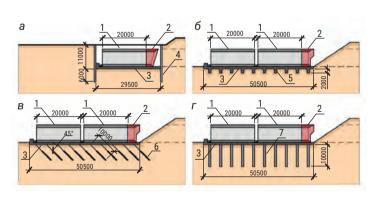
Виды конструкций (а-г) монтажного стапеля: 1 — крупногабаритная тоннельная секция; 2 — ножевая секция; 3 — плита стапеля; 4 — ограждающая конструкция котлована; 5 — ребро; 6 — грунтовый анкер; 7 — буронабивная свая
